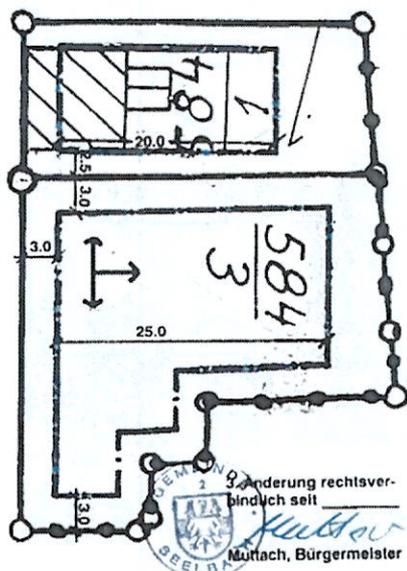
Bebauungsplan „Ortskern Nord“ mit schematischer Eintragung des Änderungsbereichs
